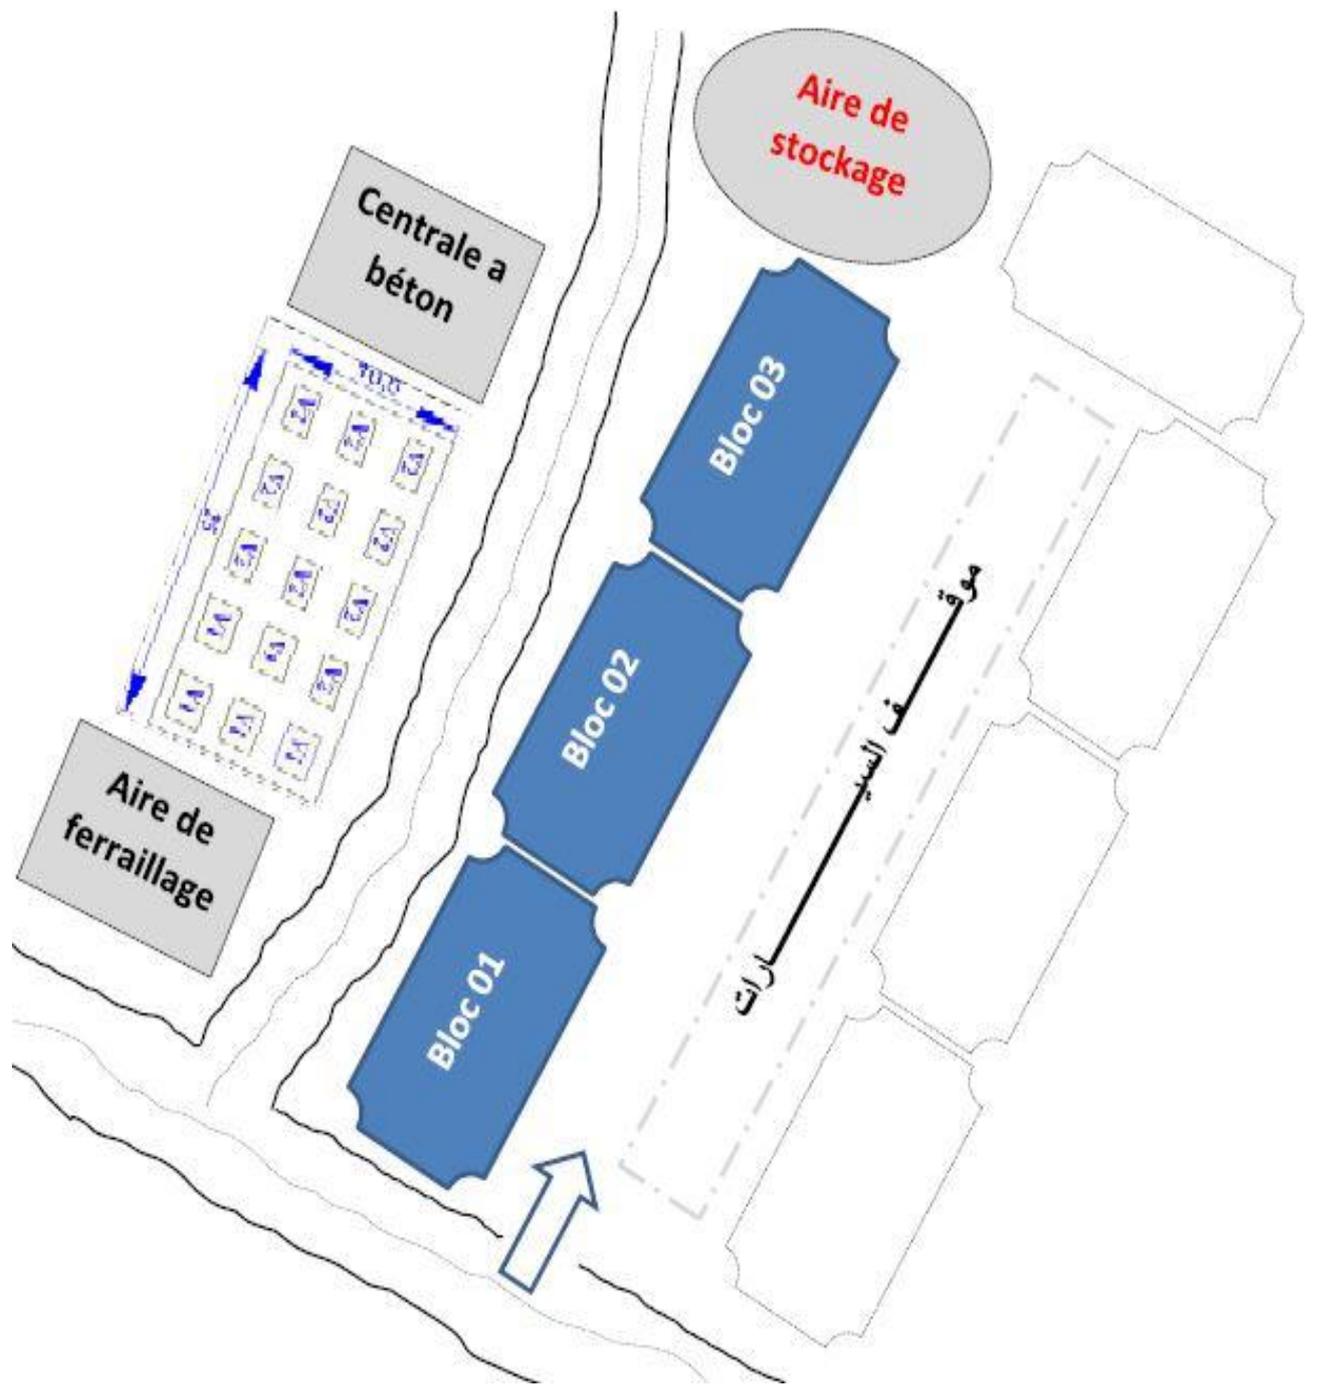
Dimension et espacement d'atelier sur terrain.
